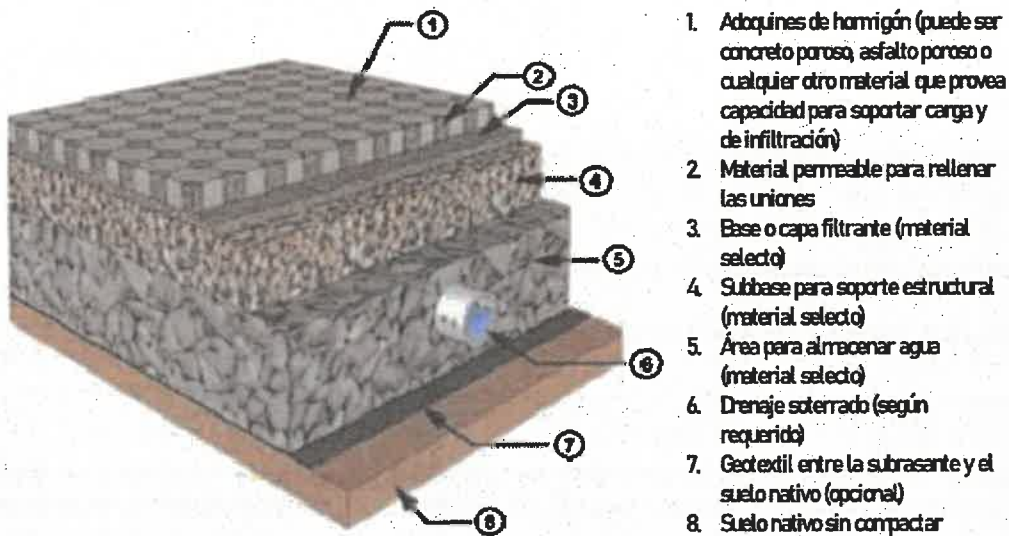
Componentes típicos de un pavimento permeable (adaptado de Freeborn et al. [4]).
